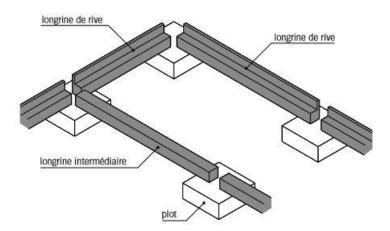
Principe de fondations par longrines et plots. Source : https://www.toutsurlebeton.fr/mise-en-oeuvre/la-longrine-de-fondation-en-beton/
